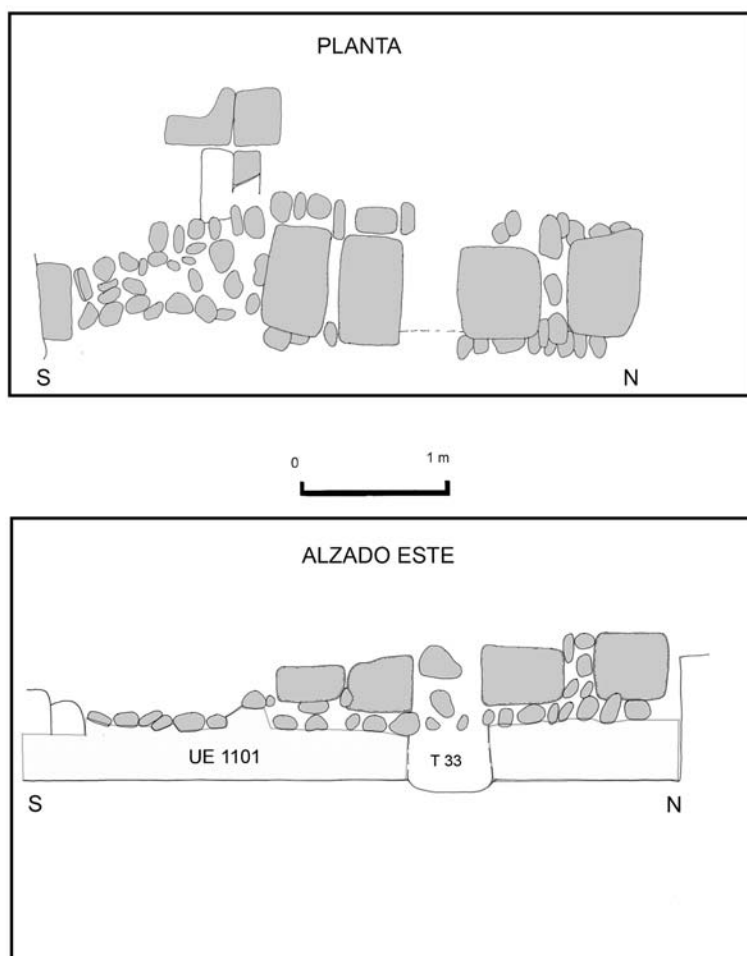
Planimetría y alzado de la unidad constructiva 14.
